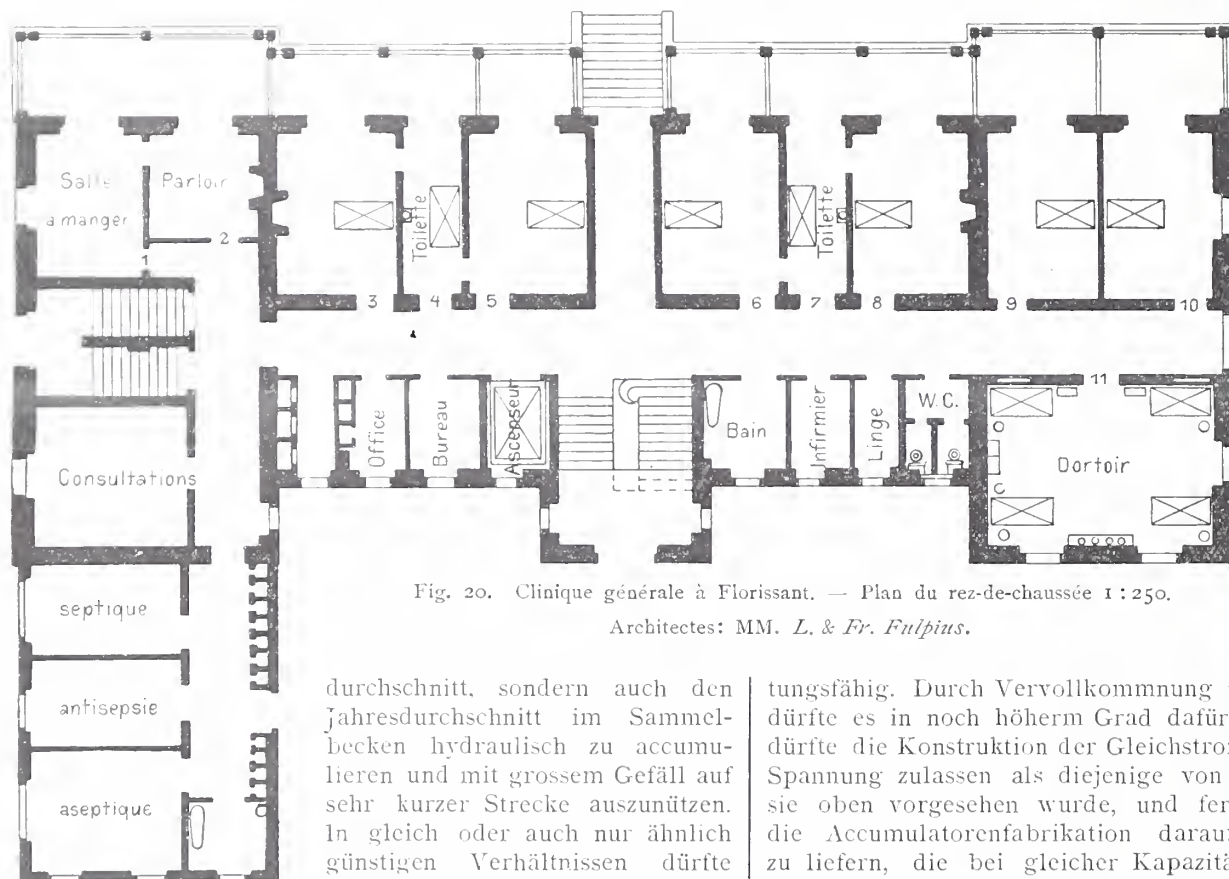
Clinique générale à Florissant. — Plan du rez-de-chaussée 1:250.
